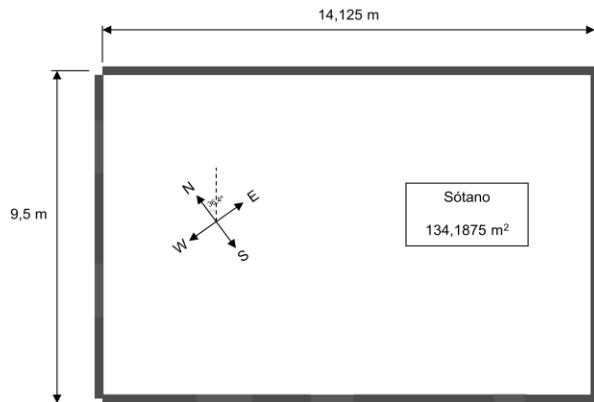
Esquema de la planta del sótano (dimensiones exteriores)
